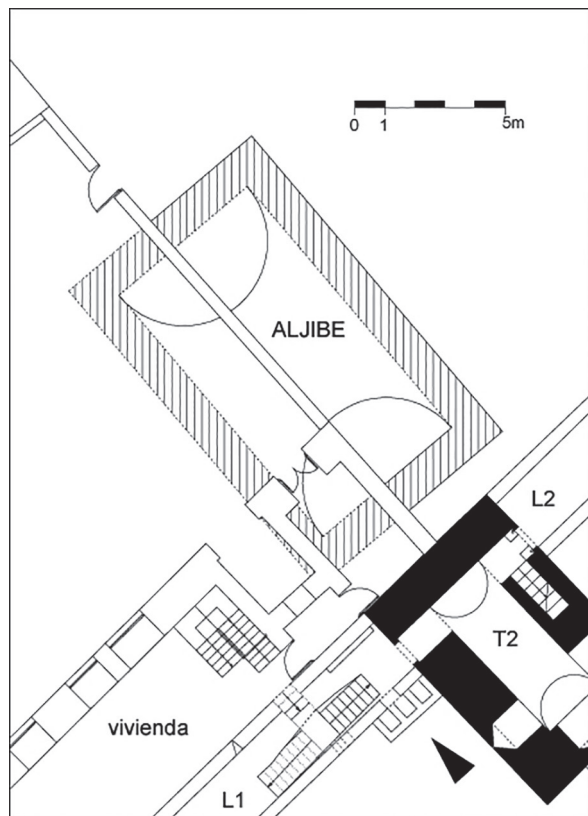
Planta del aljibe, junto a los Lienzos 1 y 2 y Torre 2 del castillo (planimetría de 2002-2003).
